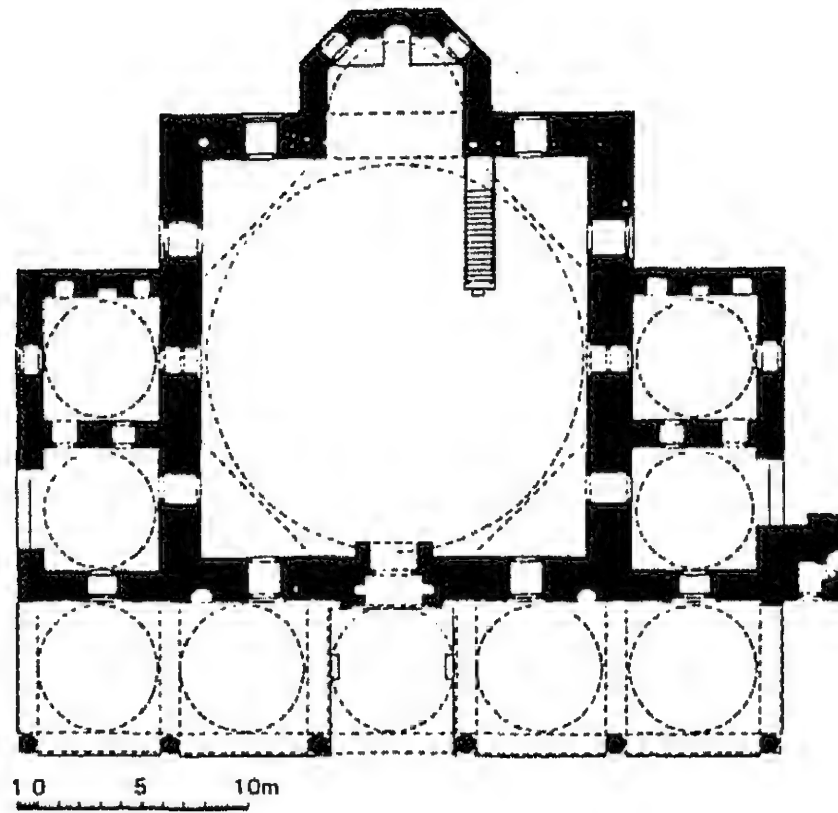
مسقط أفقي لمسجد حاجي شهاب الدين باشا في أدرنة (عن : كوران) .
